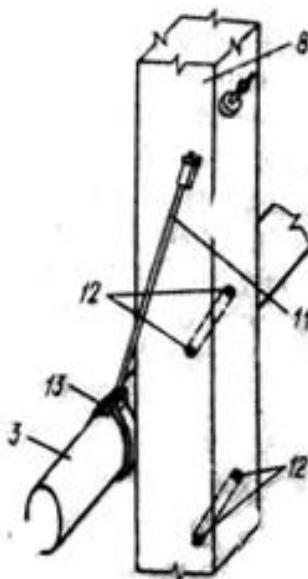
Крепление трубопровода к колонне: 3 – трубопровод, 8 – колонна, 11 – стержень; 12 – наклонные отверстия; 13 – хомут
